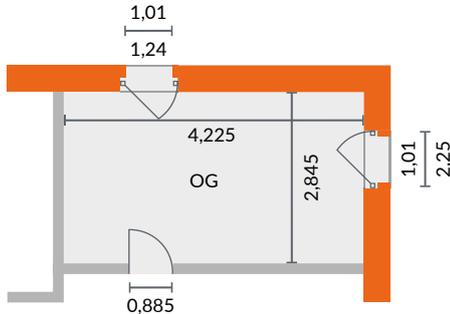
Grundriss des zu betrachtenden Eckraumes (Maßangaben in m)
